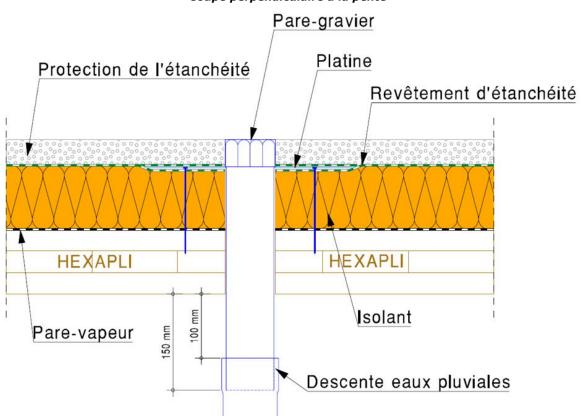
Toiture chaude isolée inaccessible - Entrée d'eaux pluviales avec pare-gravier Coupe perpendiculaire à la pente
